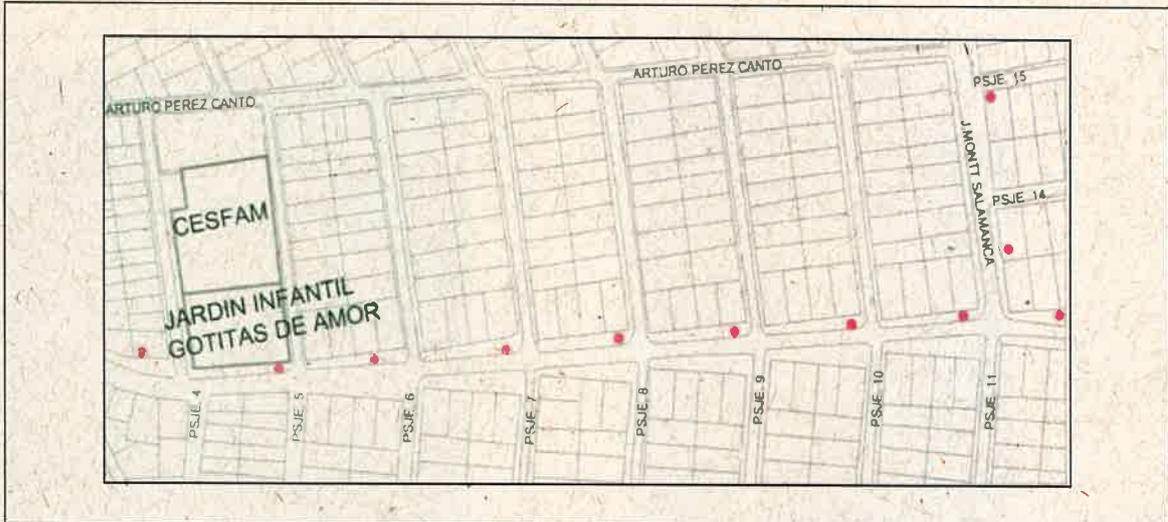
Detalle planta, plano ubicación distribución de basureros.
